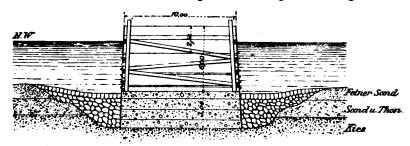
Eiserner Mantel mit Betondichtung und Versteifung der Wandungen.
